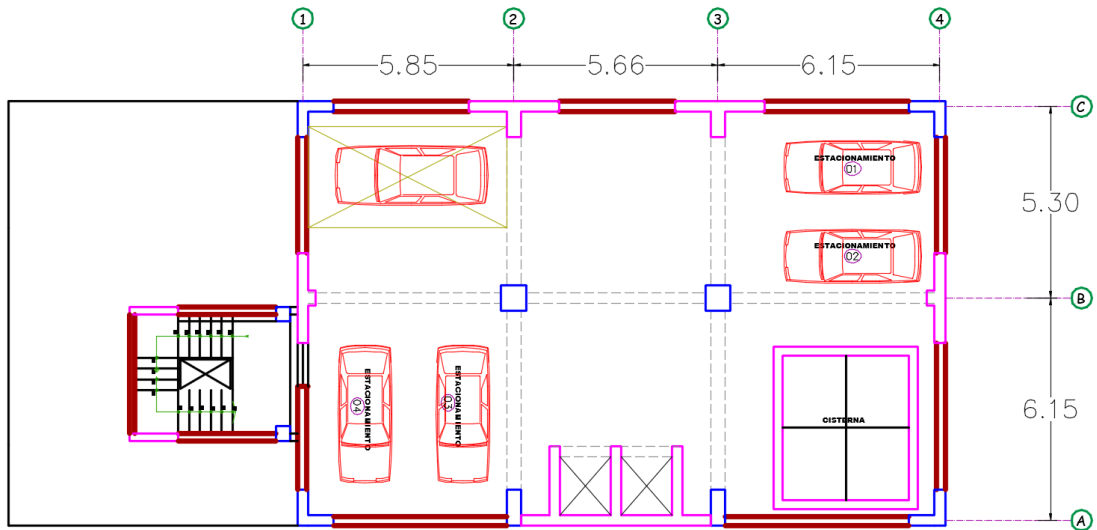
Plano Arquitectónico de la Planta 1° piso.
